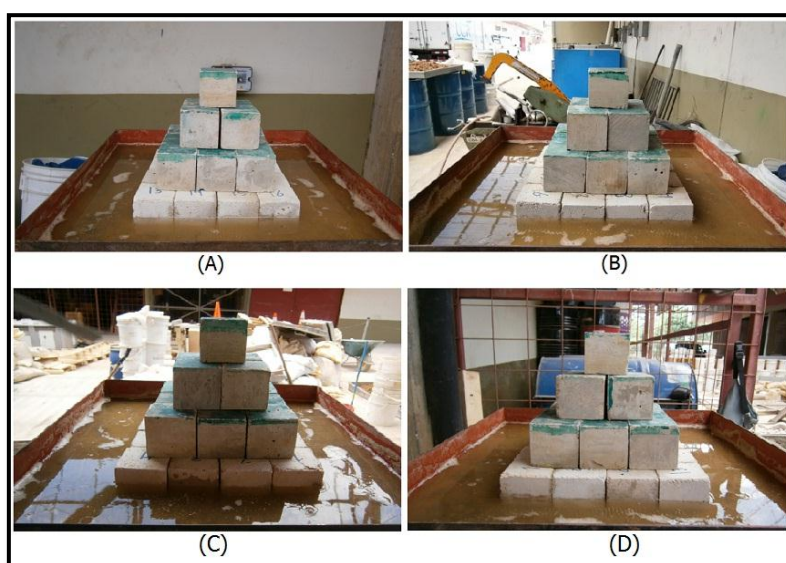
Resultado del modelo a escala combinación 75/25. (A) Fachada norte, (B) fachada este, (C) fachada sur, (D) fachada oeste
